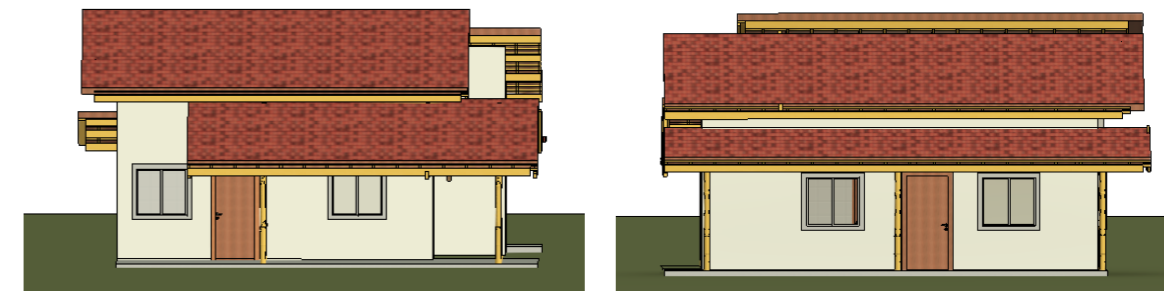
Fachadas frontal (a) e posterior (b) da habitação. Fonte: elaborado pelos autores.
